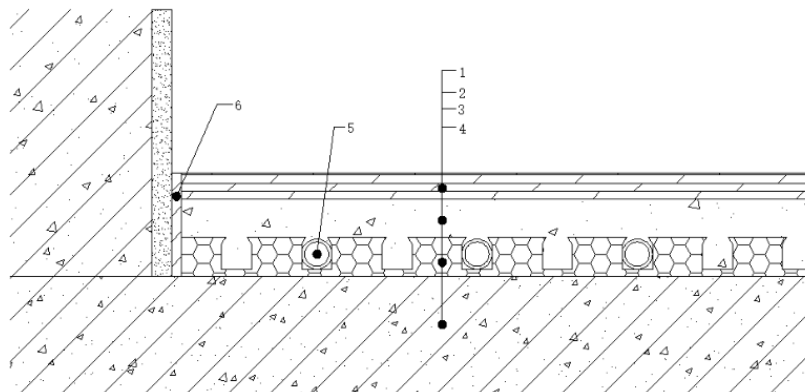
高抗裂混凝土温隔声系统构造二
